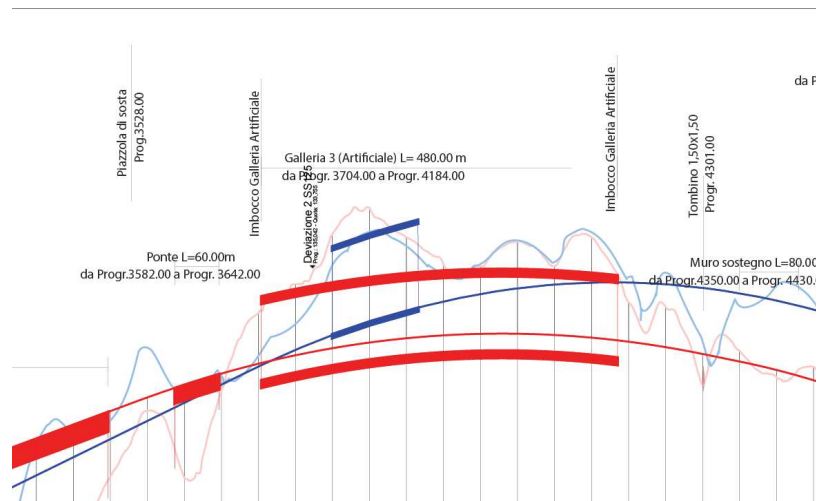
Raffronto tratto in galleria artificiale - profilo
